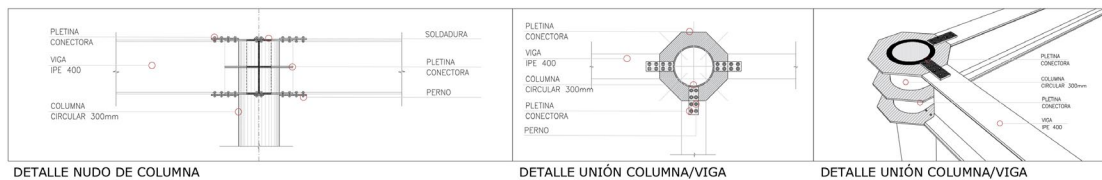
Detalle de unión viga- columna. Elaboración: (Pérez, 2018)
